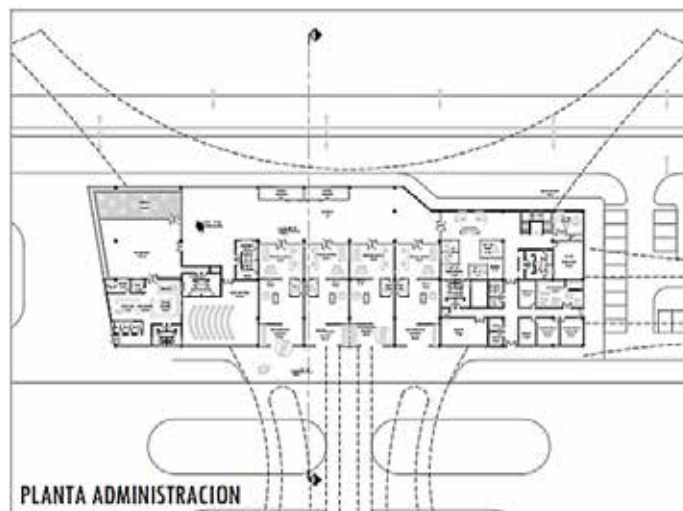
Planta baja edificación administrativa. Fuente: Sosa (2020)
